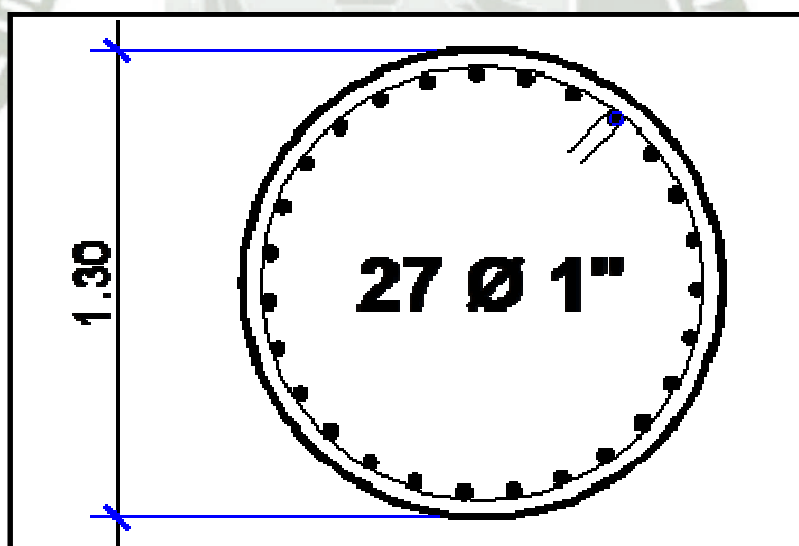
Pre-dimensionamiento de Columnas para Pilares de Concreto Armado,
